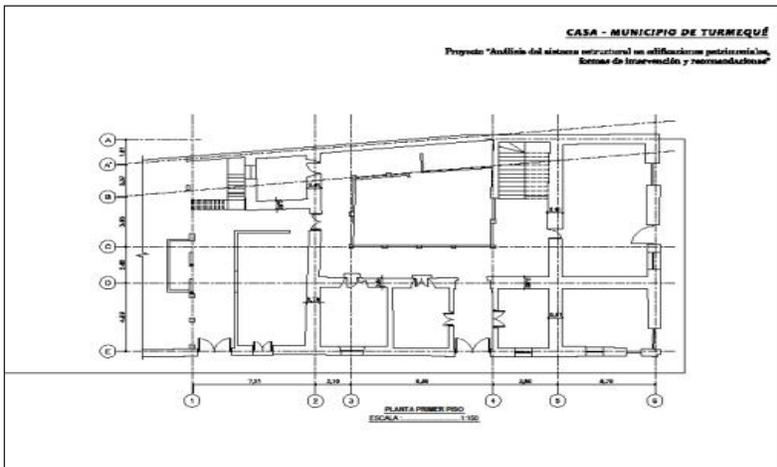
Plano de planta primer piso. Fuente: Elaboración propia.
